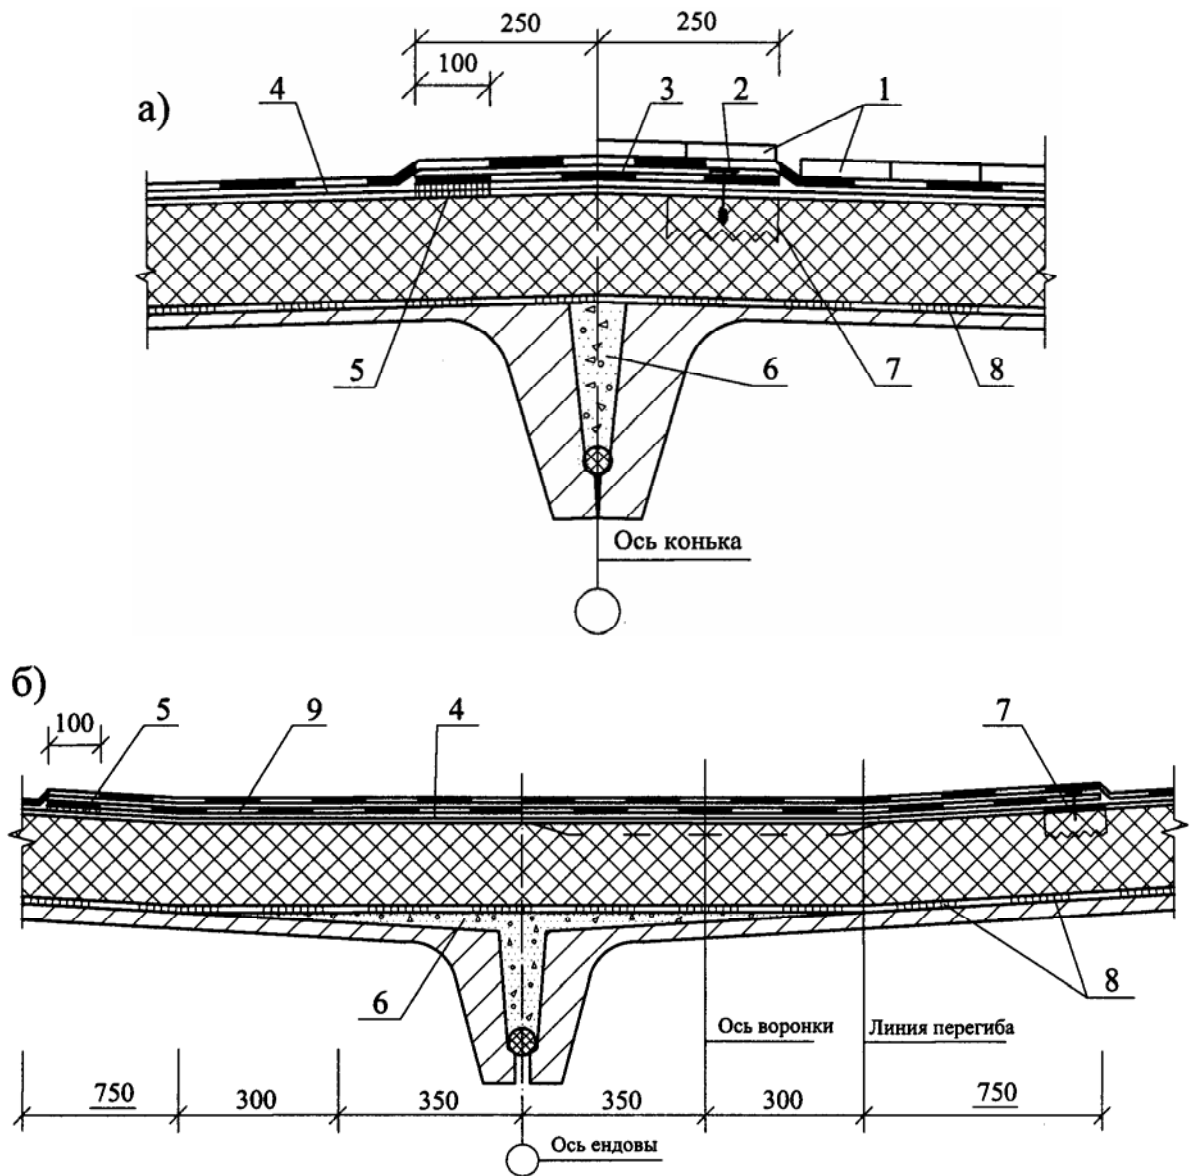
Водоизоляционный ковёр на коньке (а) и в ендове (б) кровли
